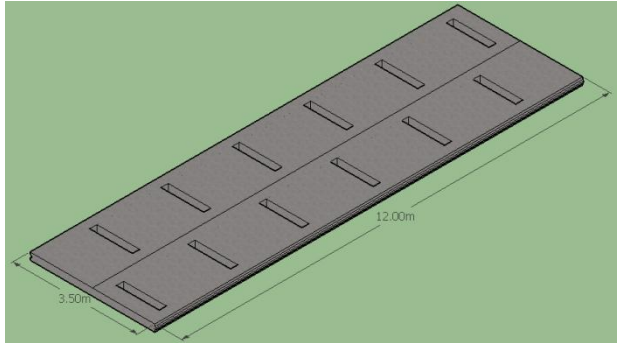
Detail Perkerasan Jalan Beton Konvensional
